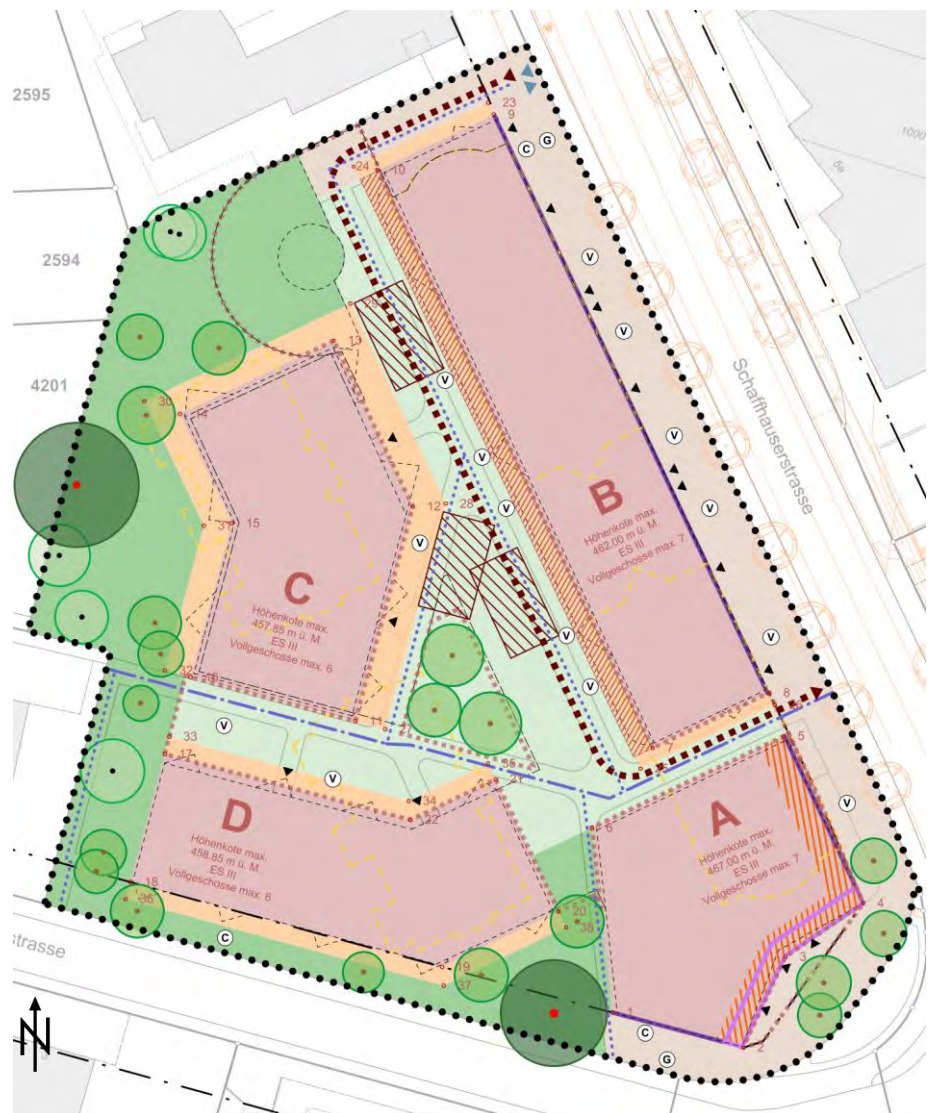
Ausschnitt privater Gestaltungsplan, Situationsplan, dat. 15.12.2025
